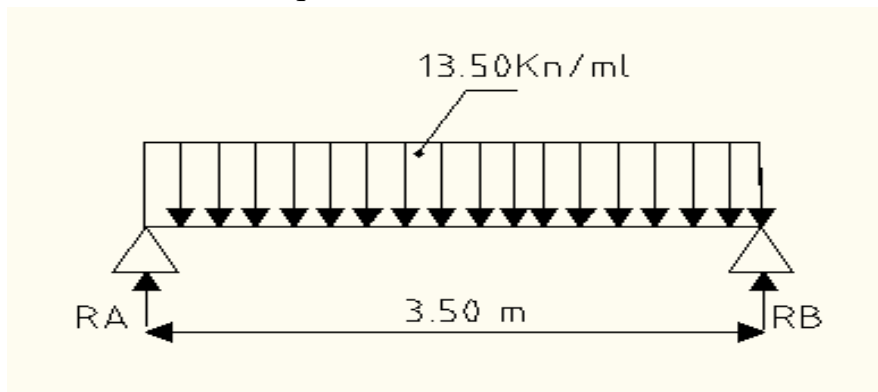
Schéma statique de la poutre continue reposant sur deux appuis a L'ELU
